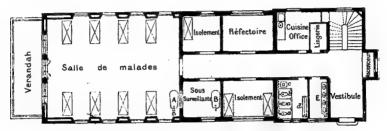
L'hopital Boucicaut; plan d'un pavillon de malades.
